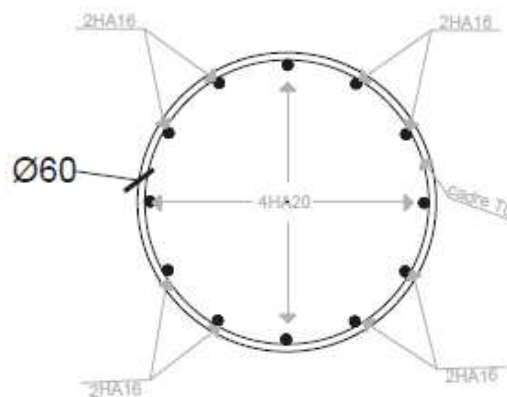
Schéma de ferrailage des poteaux circulaire
